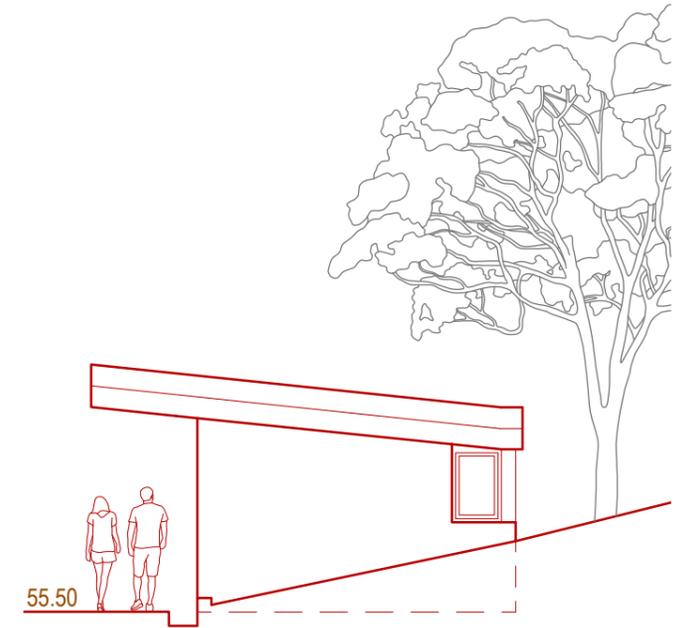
Alçado Norte Instalações Sanitárias entrada Sul
